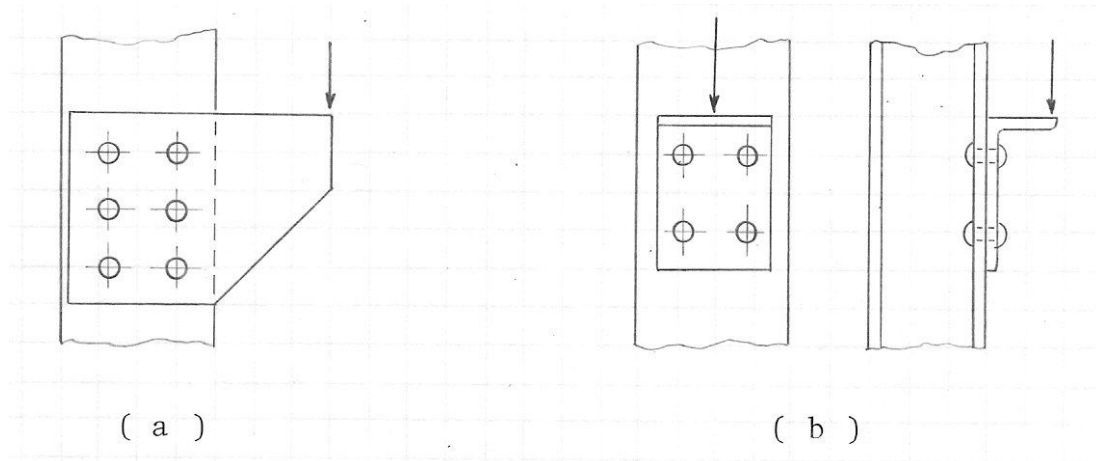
Tipos de ligações parafusadas excêntricas
